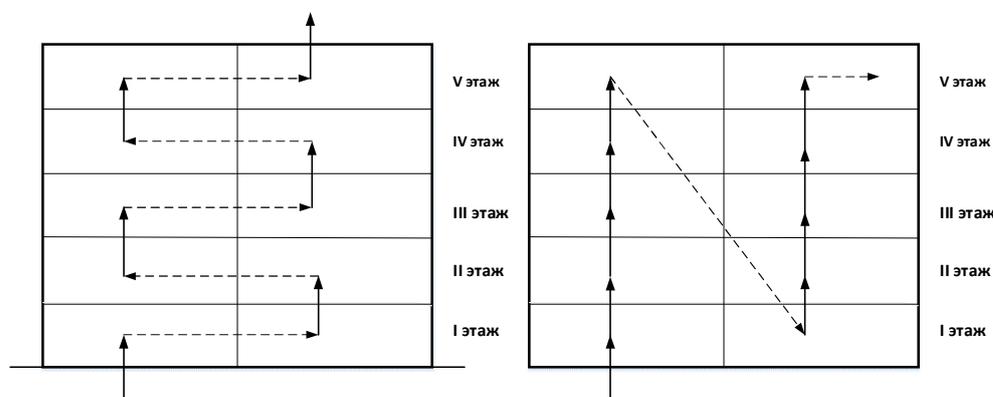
Схемы возведения многоэтажных зданий: горизонтально восходящая и вертикально восходящая
